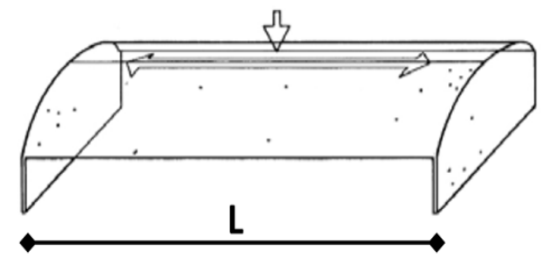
Esquema general Bóveda en Viga Laminar. Fuente: Requena Ruiz, Ignacio [3]
